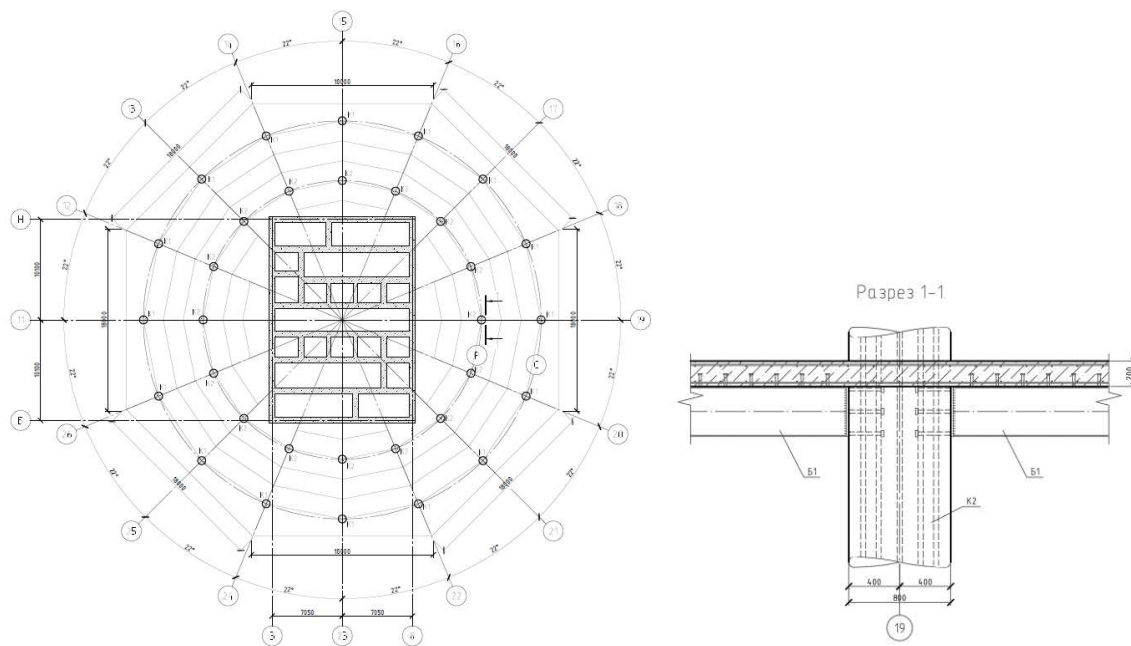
Схема расположения железобетонных колонн на отм. +4,200 (Вариант 1)
